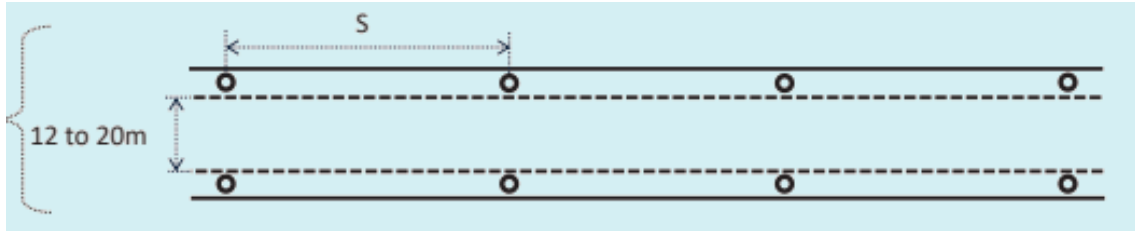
ऑपोजिट अरेंजमेंट (Opposite arrangement)
